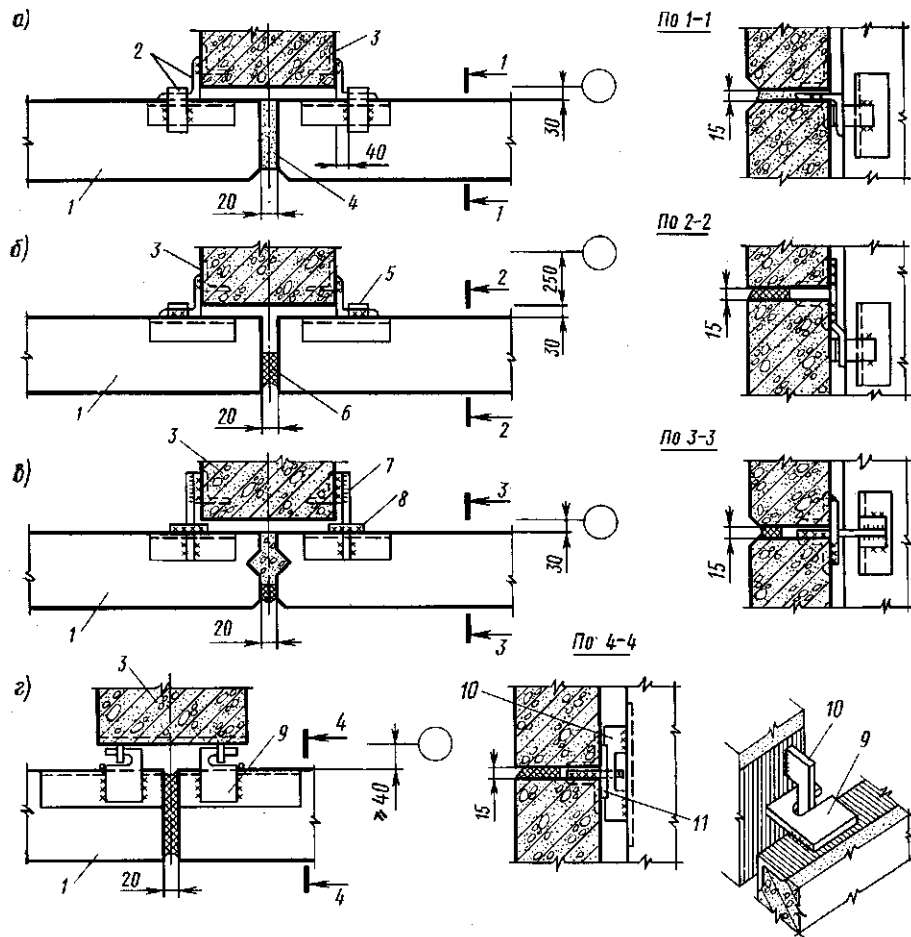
Детали крепления стеновых панелей к колоннам:
